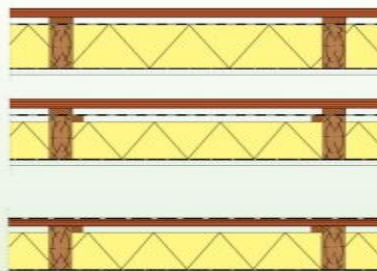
Verwendete Dachkonstruktionen im Wohnungsbau. POLMETAL GR88 – Montageanleitung – DACHPANEELLE MIT STEHFALZ
